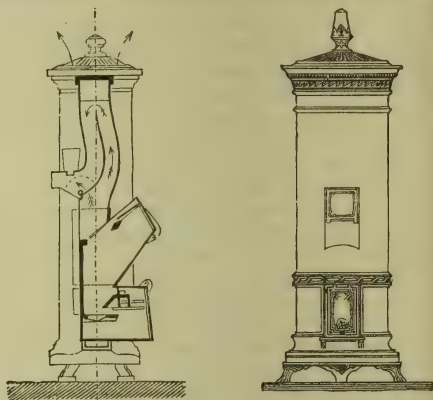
u. Fig. 2723. Räuffers Schachtofen mit Mantel.
